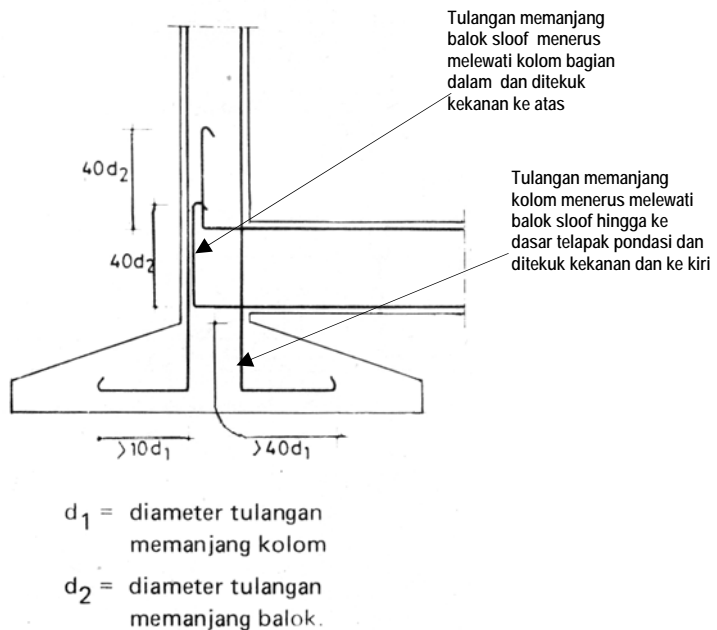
Detail penulangan pada hubungan kolom tengah dengan sloof
